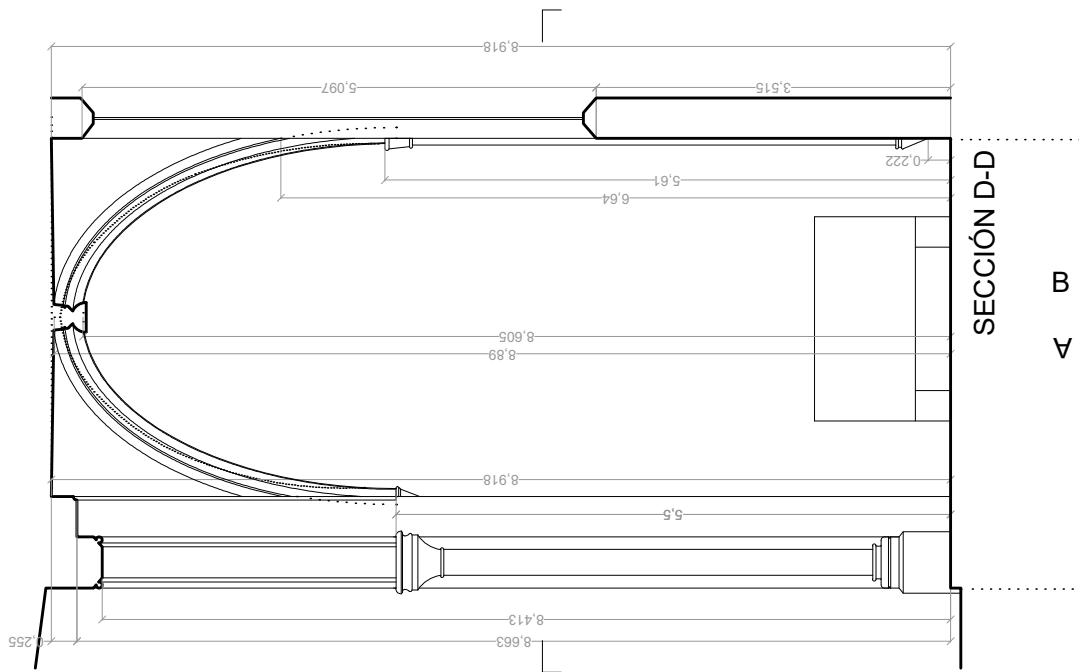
Representación a escala 1/75 planta y sección acotado (cotas en metros).
